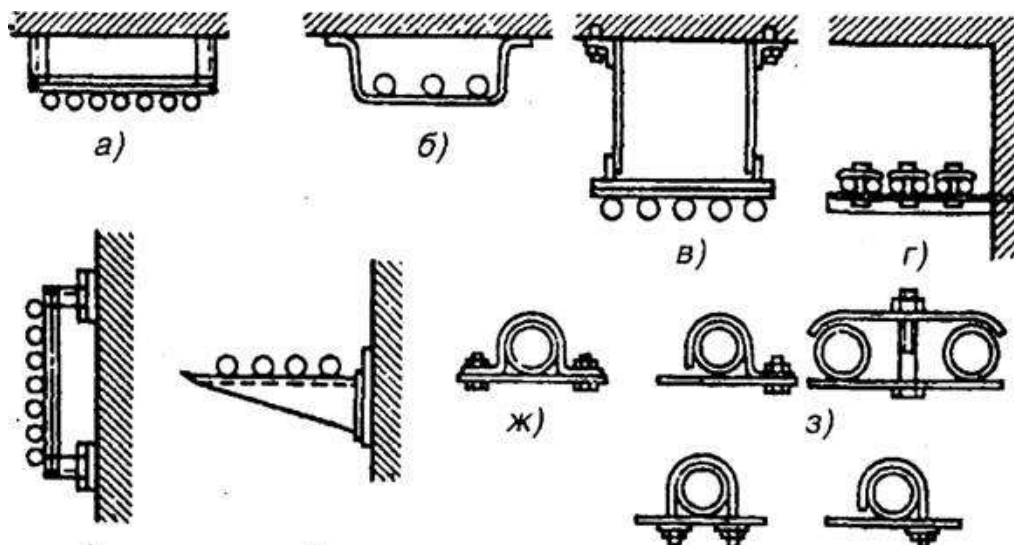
Способы крепления труб к опорным конструкциям:
